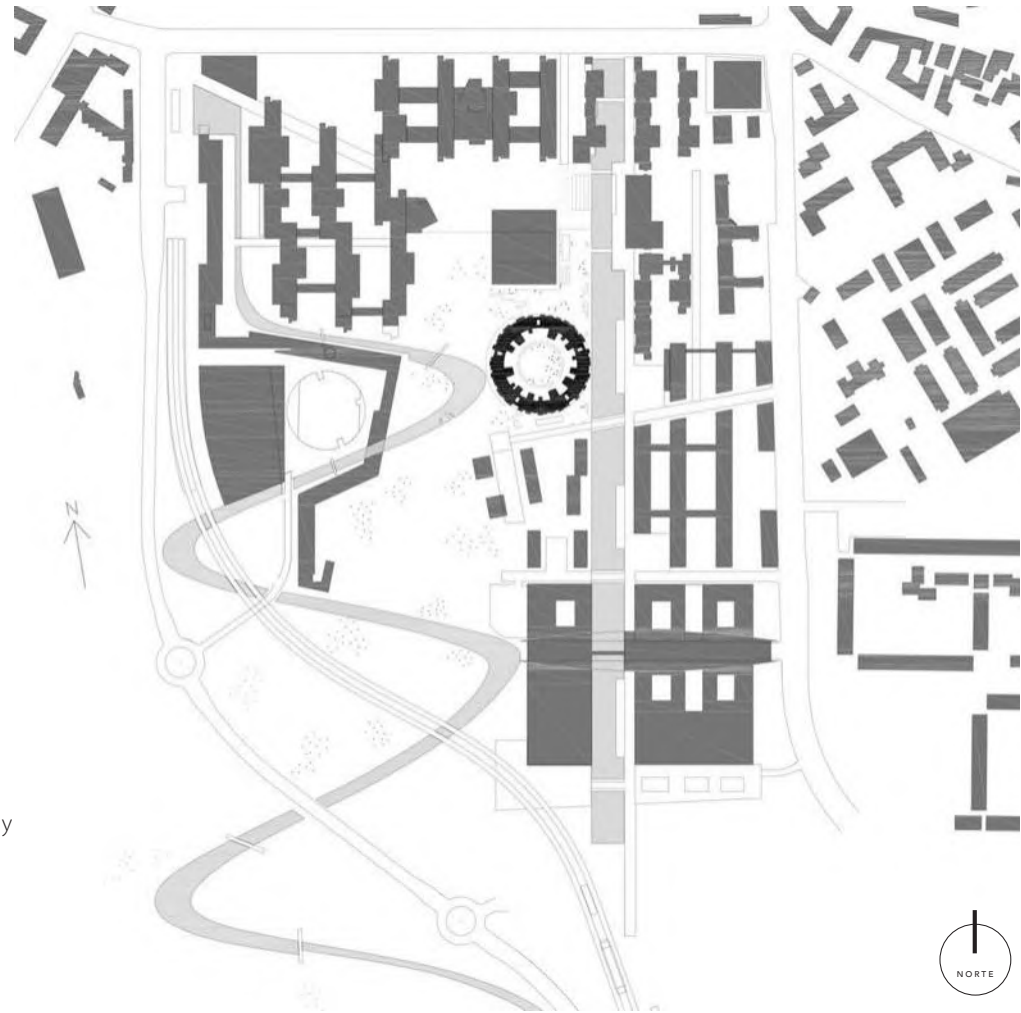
Planta de conjunto, Edificio Tietgen. Tomado de Archdaily
